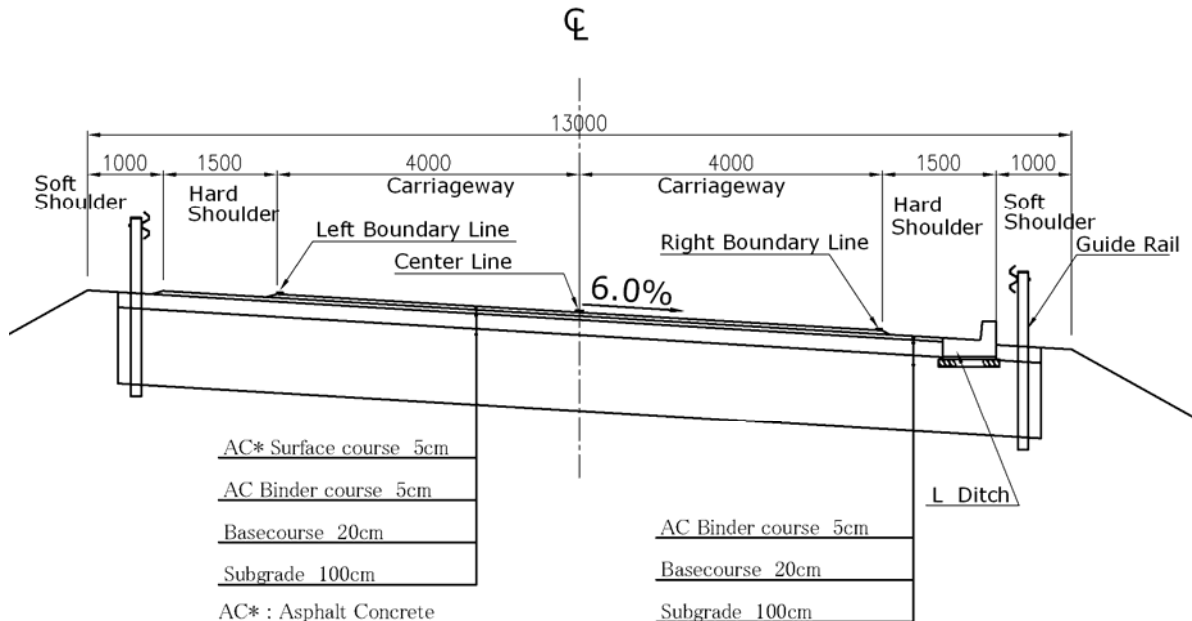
Profil en travers-type de la voie d'accès au pont Kaaka
